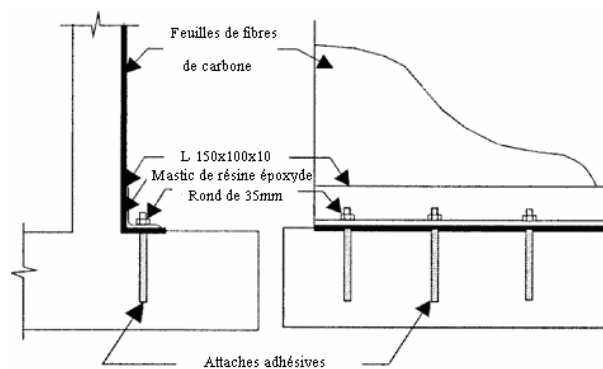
Système d'ancrage du TFC à la base du mur.[3]
